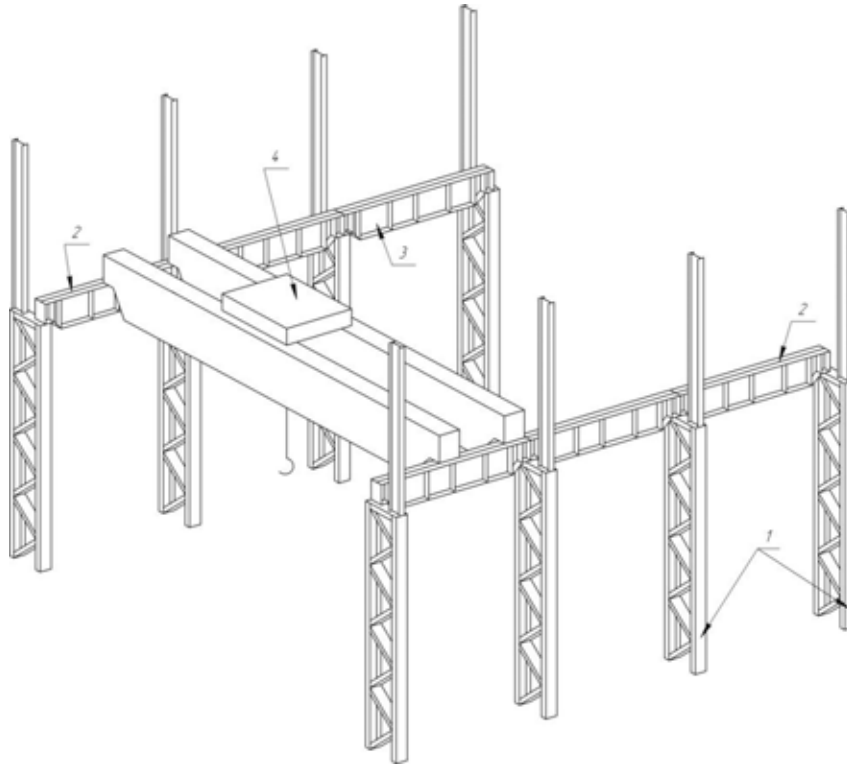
Принципиальная схема расположения несущих и подкрановых конструкций промышленного здания: 1 – колонны, 2 – крановый рельс, 3 – подкрановая балка, 4 – мостовой кран
